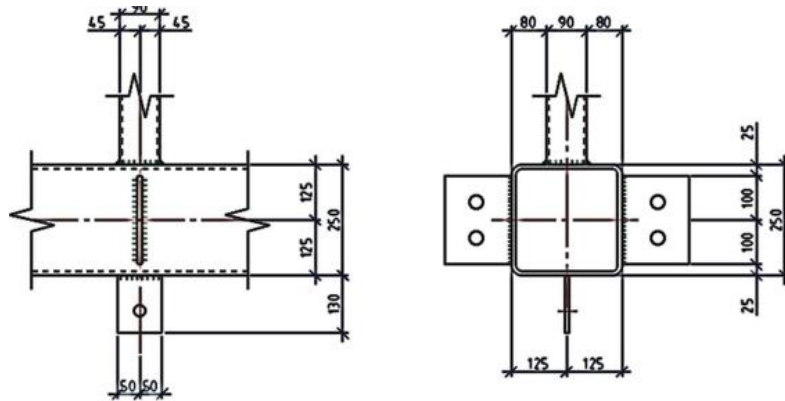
Вузол примикання стійки до нижнього пояса
